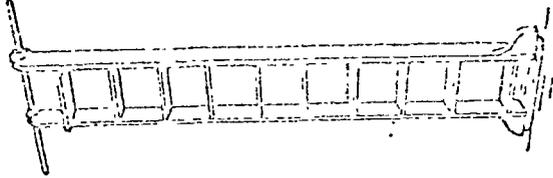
Escalera móvil apoyada sobre un rail elevado que sirve de guía.
